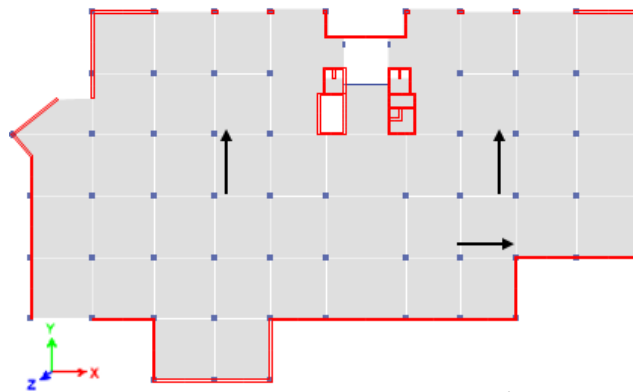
Esquema de ubicación de sensores en la Planta baja de la estructura. Instrumentación Tipo 1.
